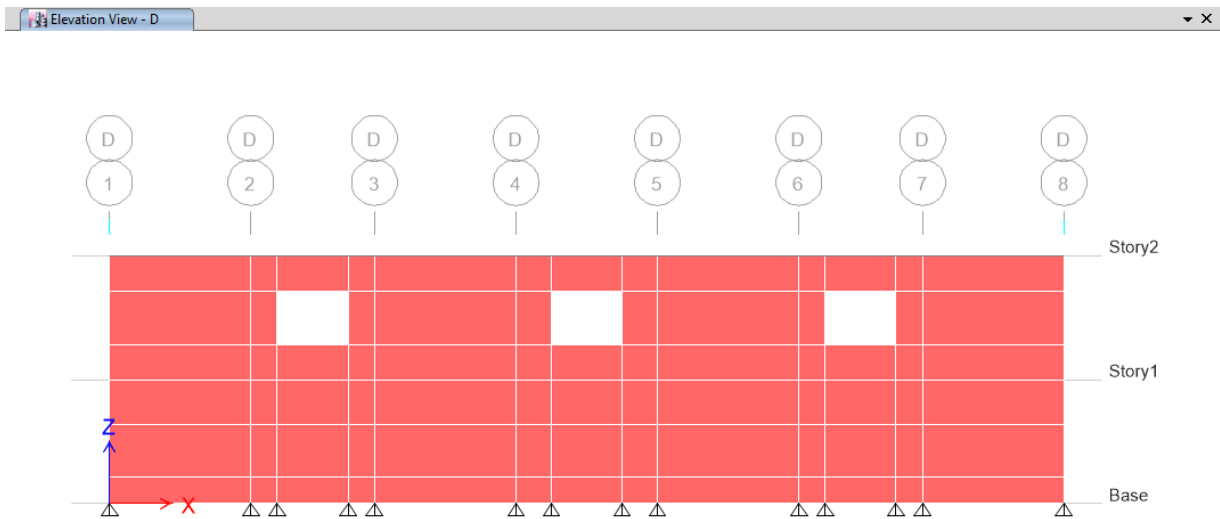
Vista en Elevación del Eje D del Edificio.
